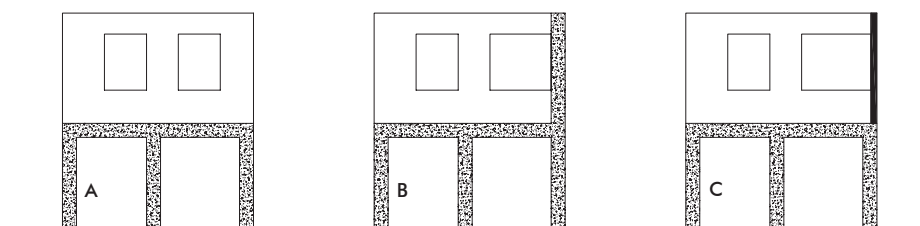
Prospetto. A-SI: Il piano inferiore è di calcestruzzo armato, il piano superiore di legno, la struttura è sovrapposta. B-NO: Al piano superiore come elementi resistenti alle azioni orizzontali c'è sia calcestruzzo armato che legno, la struttura è mista. C-SI: al piano superiore la struttura di legno è sufficiente a resistere alle azioni orizzontali, il pilastro di acciaio è strutturalmente una biella e si inserisce solo per portare i carichi verticali.
